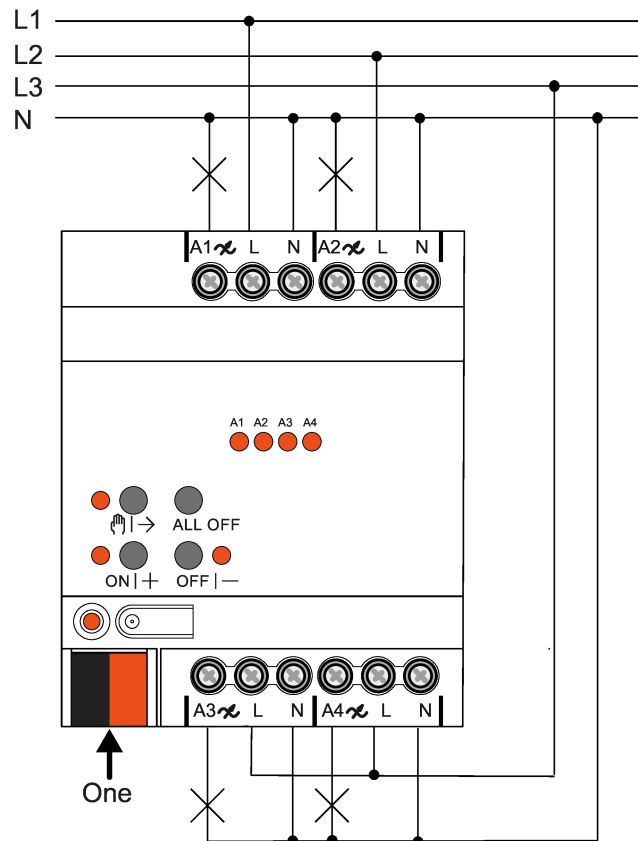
Collegamento dell'apparecchio (esempio di collegamento)
